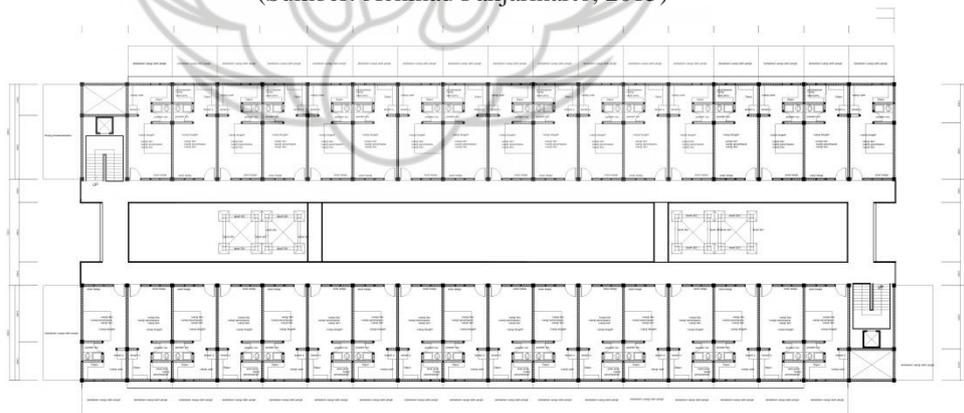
Denah Lantai Dasar dan dua Blok A
